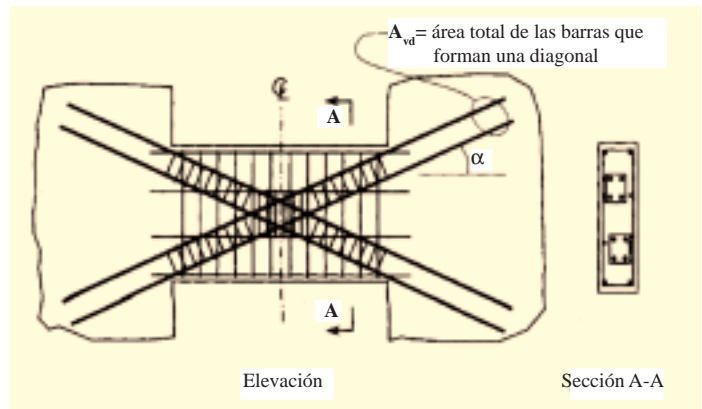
Viga de acoplamiento con armadura orientada diagonalmente.
